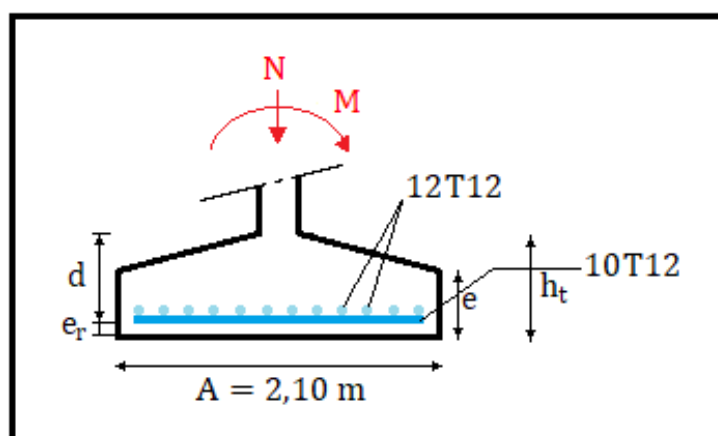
Vue du ferrailage des semelles isolées.
